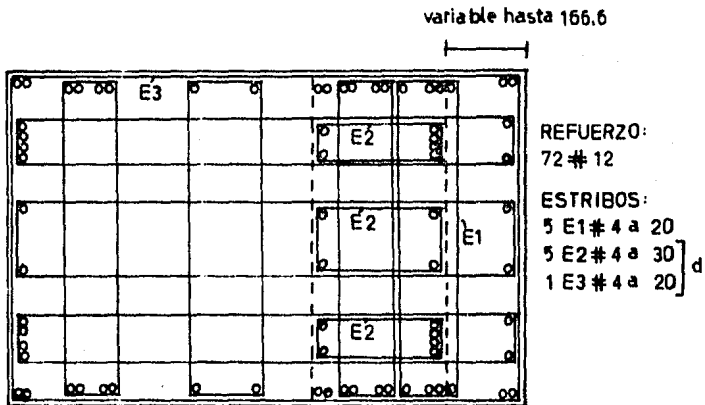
CORTE DE LAS COLUMNAS C-27
